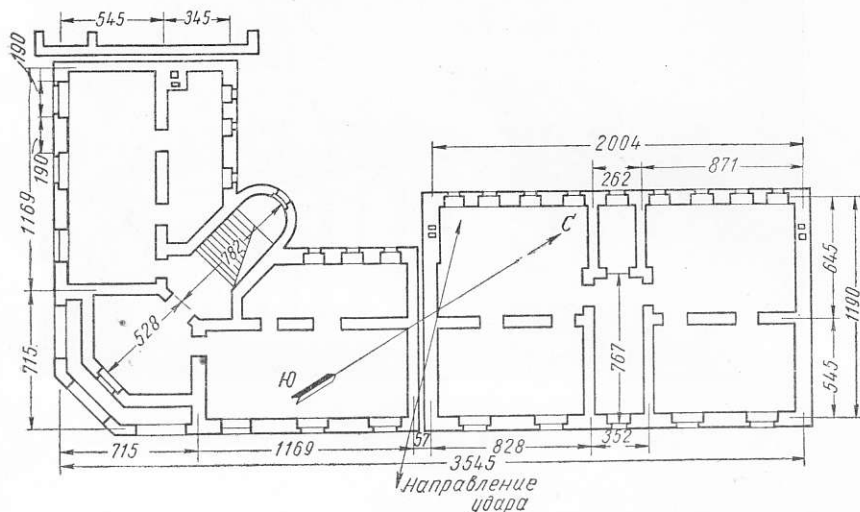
План 1-го этажа 3-этажного жилого дома на углу ул. Гоголя и Кушкинской ул.
